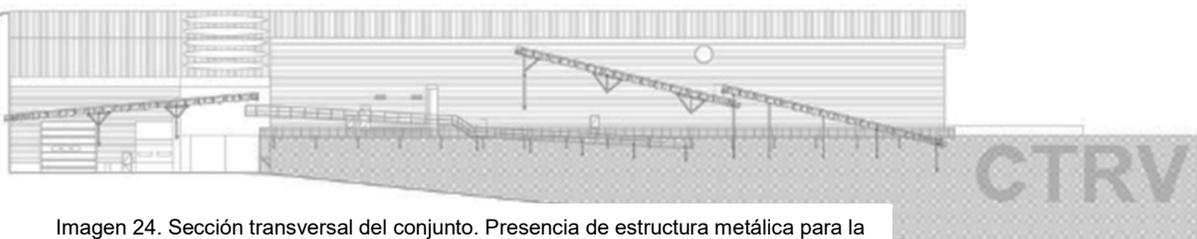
Sección transversal del conjunto. Presencia de estructura metálica para la creación de grandes luces.
